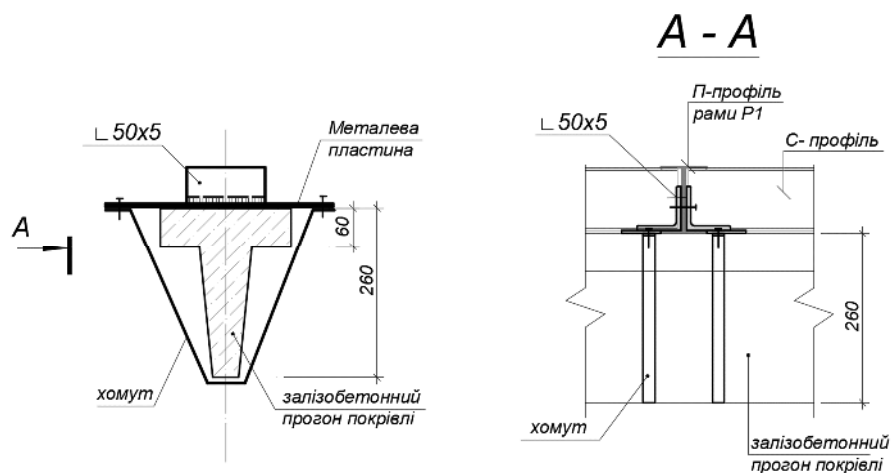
Вузол кріплення рами P1 до залізобетонного прогону
